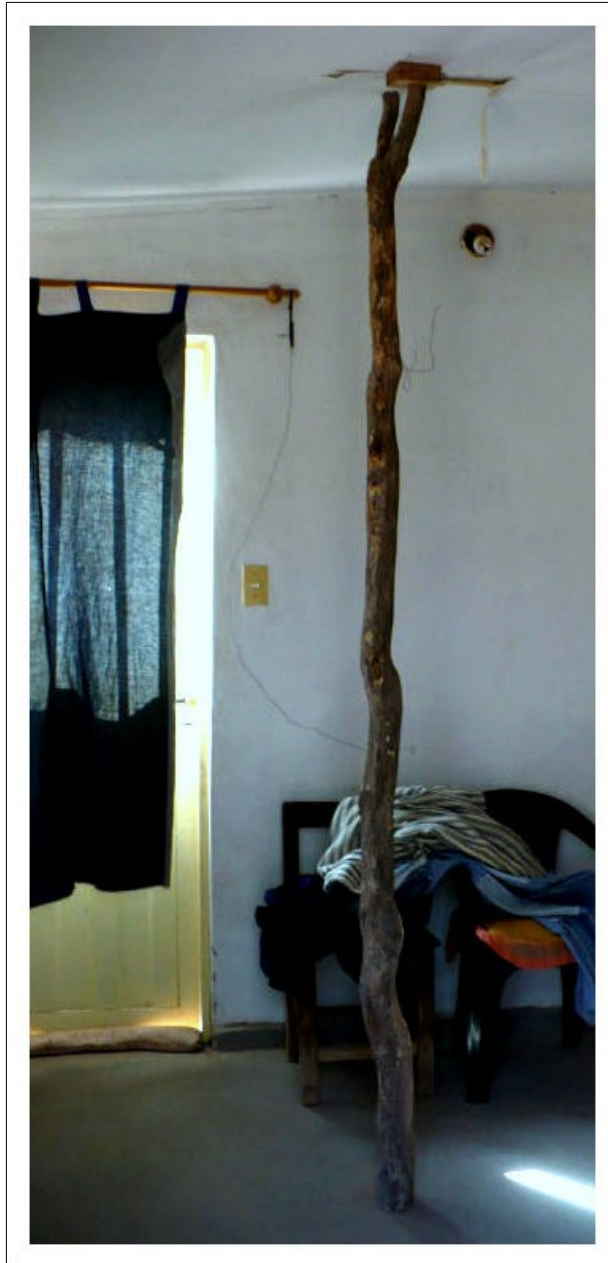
A; a. Grietas en el revoque de las paredes.
